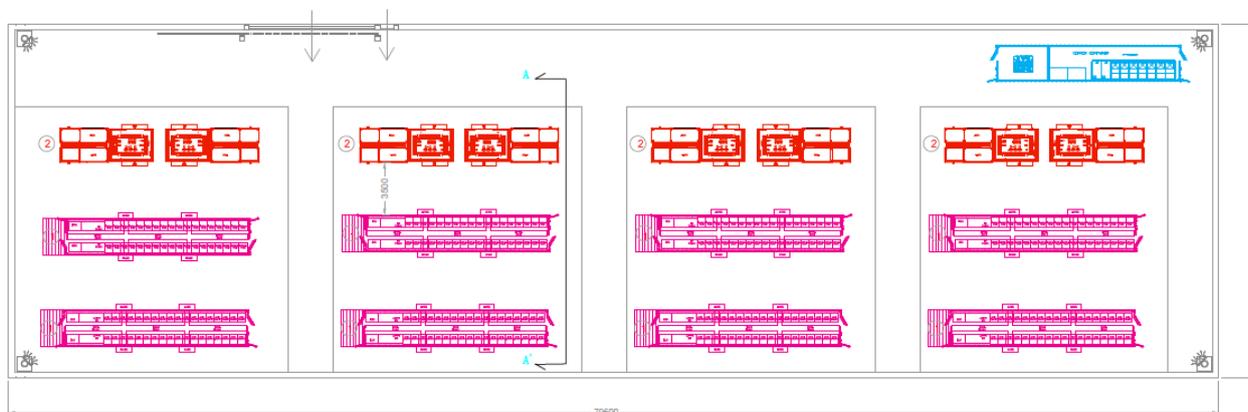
planimetria elettromeccanica della precedente dell'impianto di Accumulo Elettrochimico.
